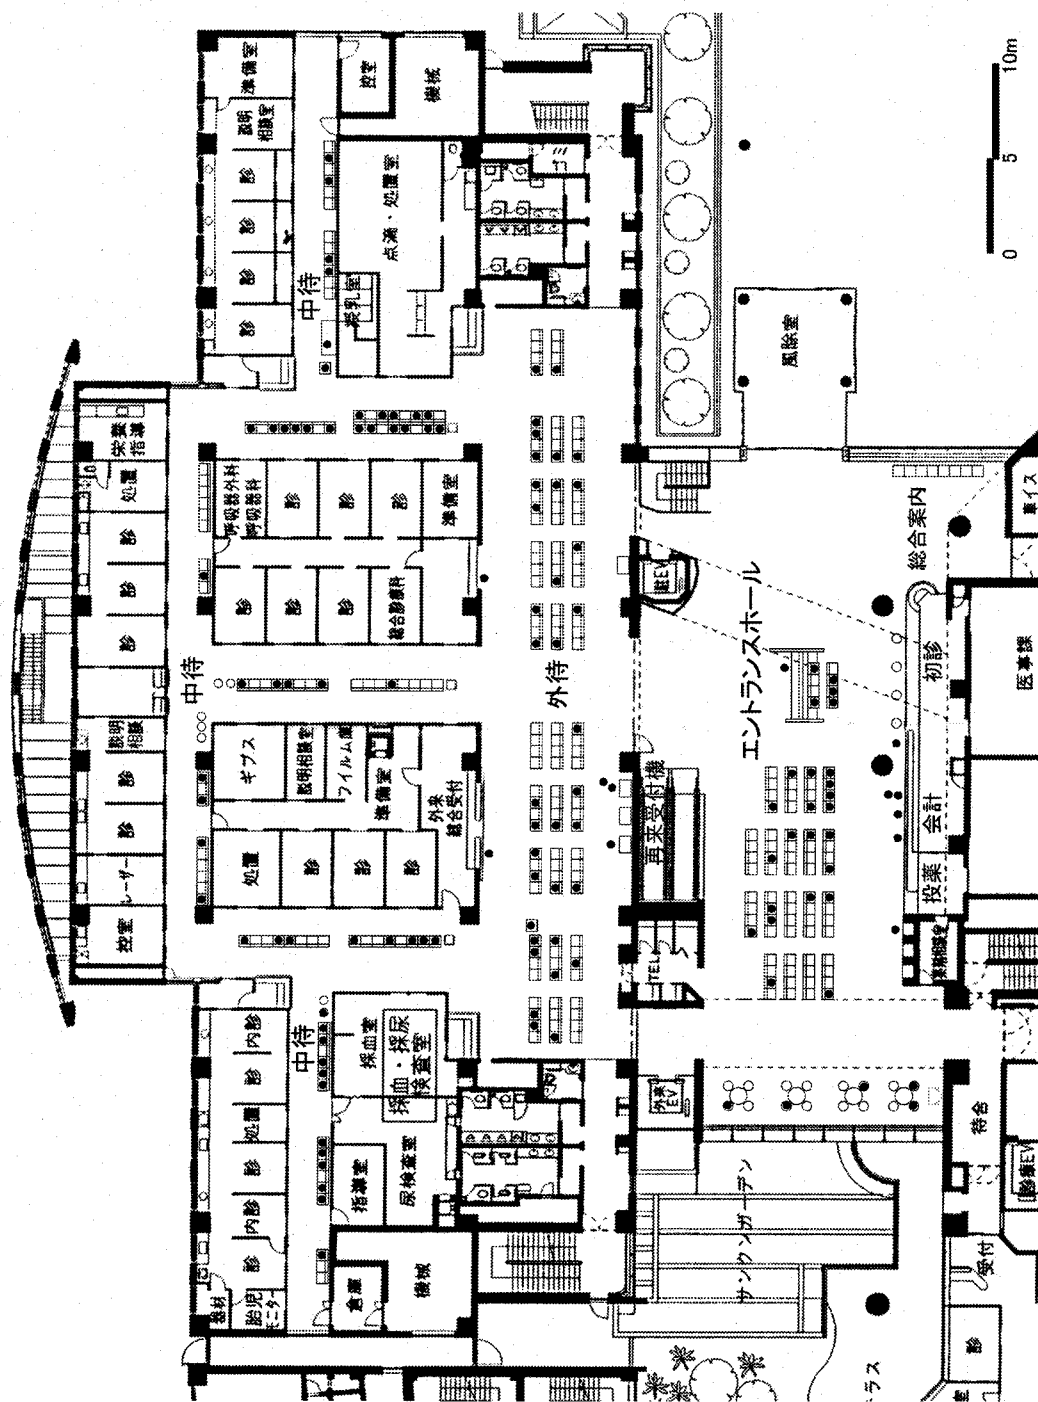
M病院1階外来およびエントランスホール平面図(2002.10.25 11:00)
